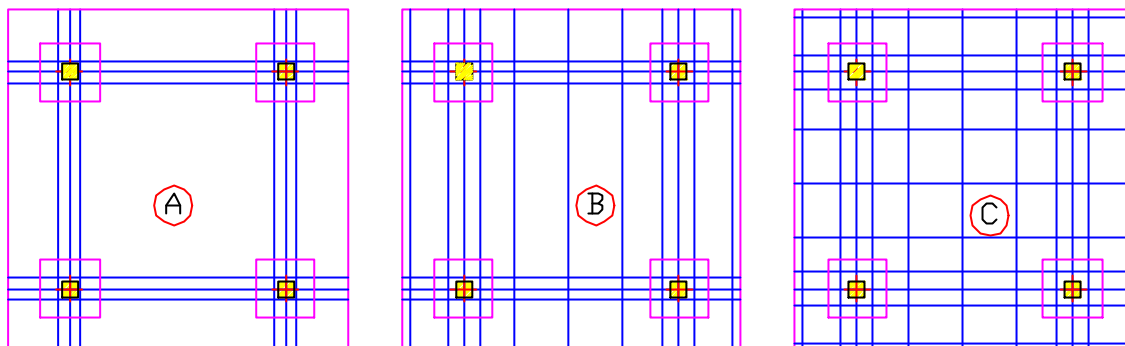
Lajes Planas Maciças com Capitéis ou com “Drop Panels”
